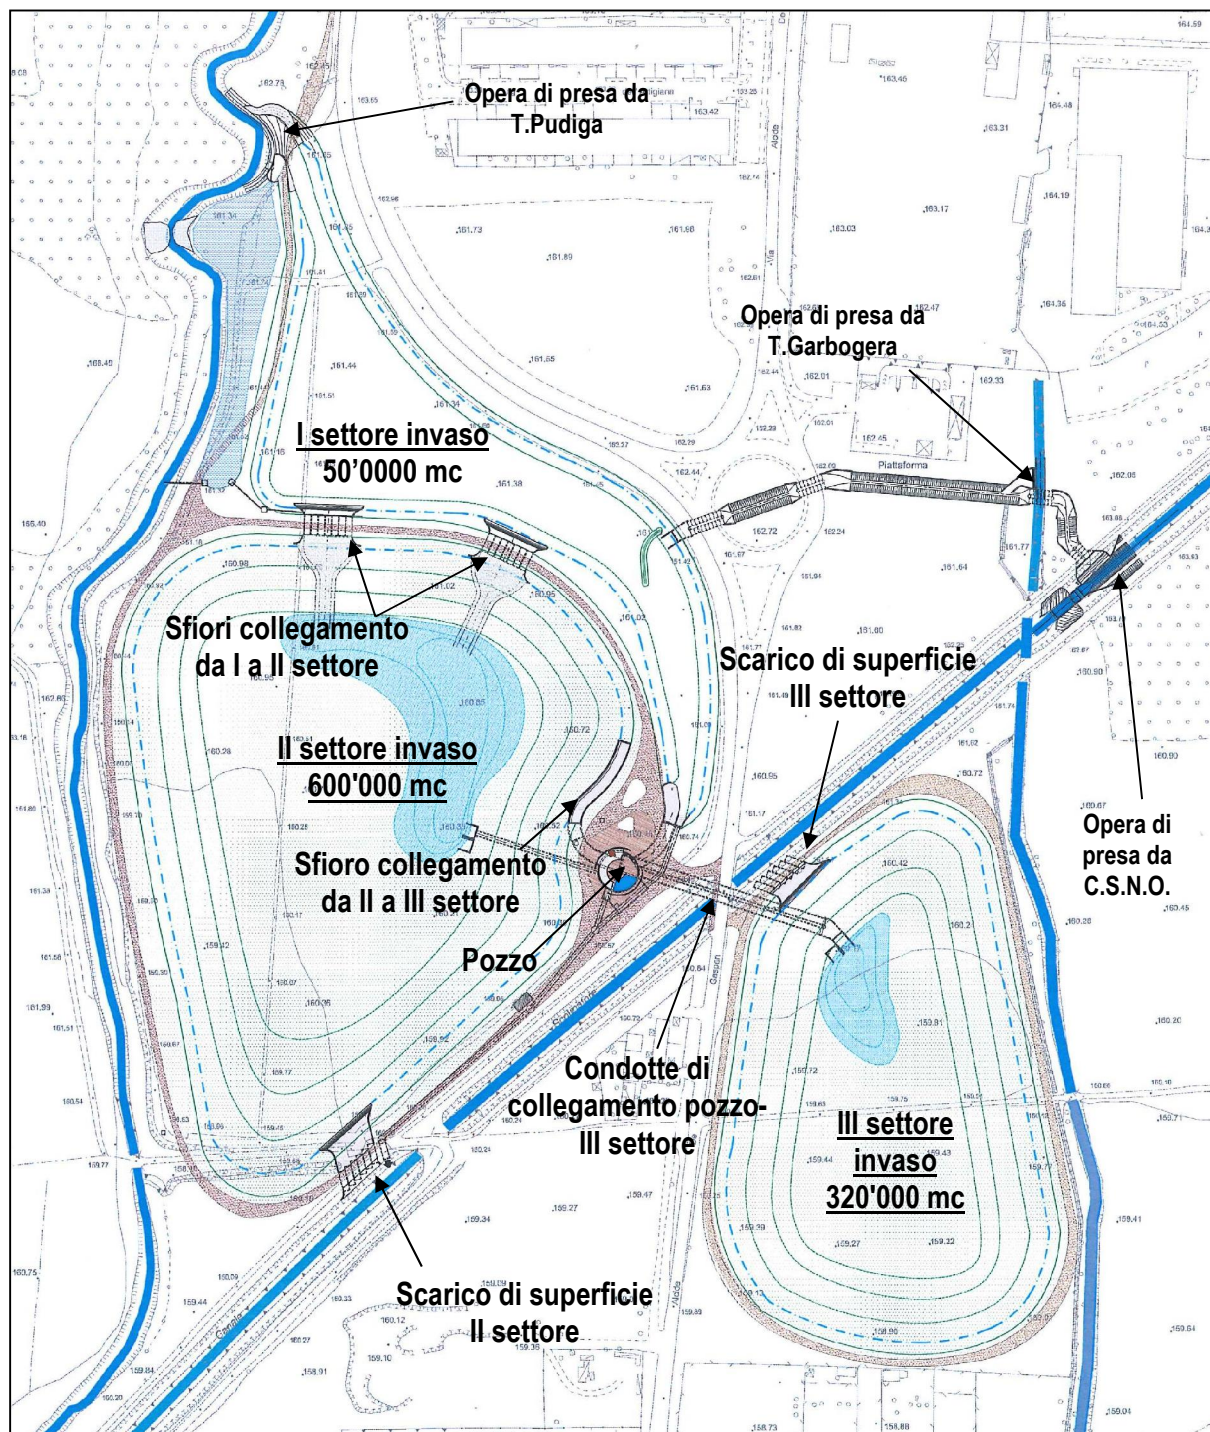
Schema planimetrico della vasca di laminazione di Senago con indicazione delle opere
